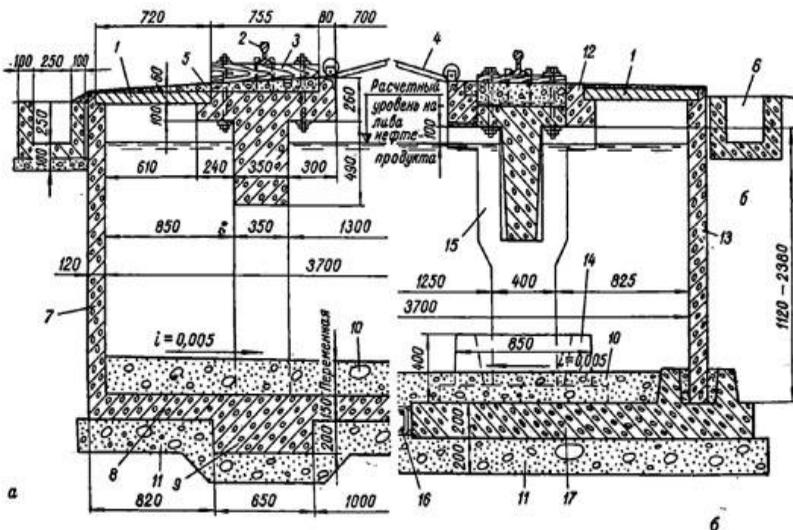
Межрельсовый сливной желоб (поперечный разрез): а – желоб из монолитного железобетона; б – желоб из сборного железобетона. 1 – распорные плиты; 2 – рельс; 3 – подкладка из дерева; 4 – двухстворчатые металлические механизированные крышки; 5 – бетон; 6 – лоток для сточных вод; 7 – стенка желоба; 8 – днище желоба; 9 – фундаментные балки; 10 – бетон для создания уклонов; 11 – бетонная подготовка; 12 – балки бортовые; 13 – стеновые панели; 14 – подколлонная плита; 15 – колонна; 16 – арматура для замоноличивания; 17 – плиты днища.
